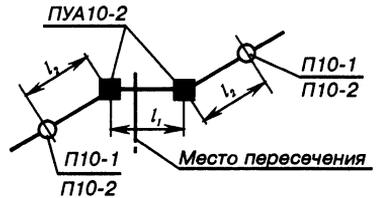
Размещение оттяжек на переходной угловой анкерной опоре ПУА10-2
